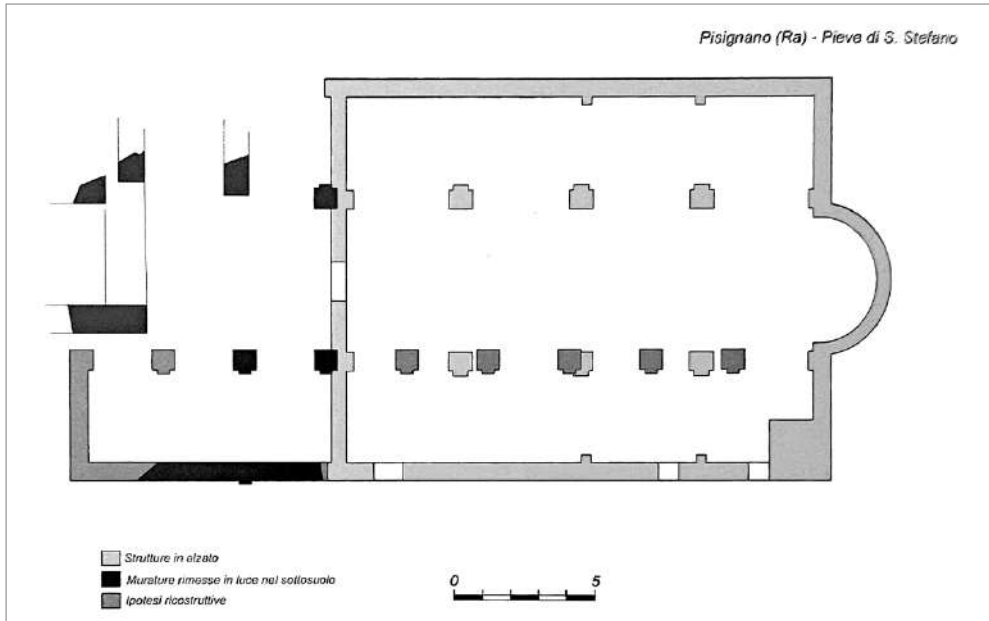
Pianta schematica della pieve, con individuazione delle strutture conservate in elevato, quelle portate in luce dagli scavi e ipotizzate (da NOVARA 2020b p. 6, fig. 8).
